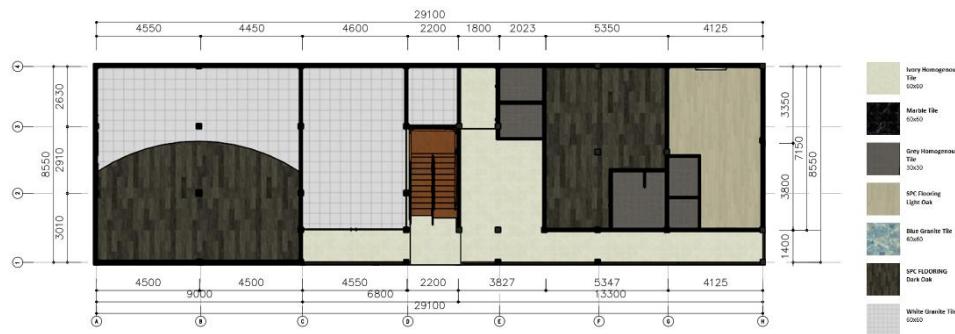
Alternatif 1 Rencana Lantai 3
